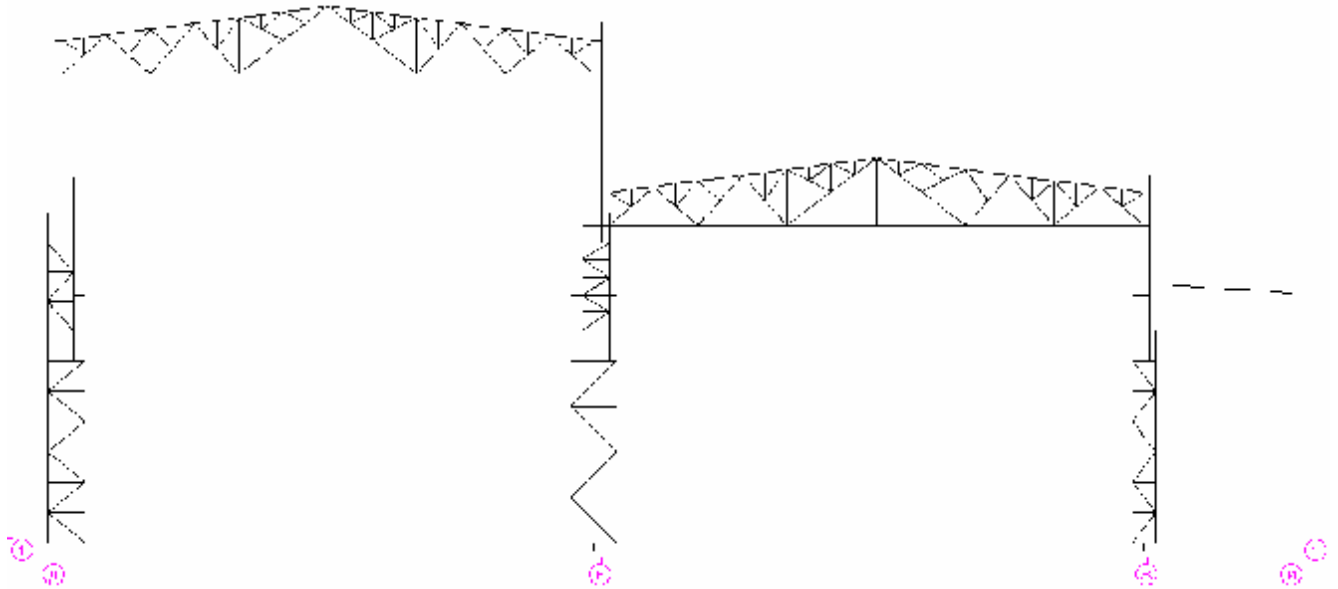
Общий вид фрагмента расчетной схемы (поперечная рама).
